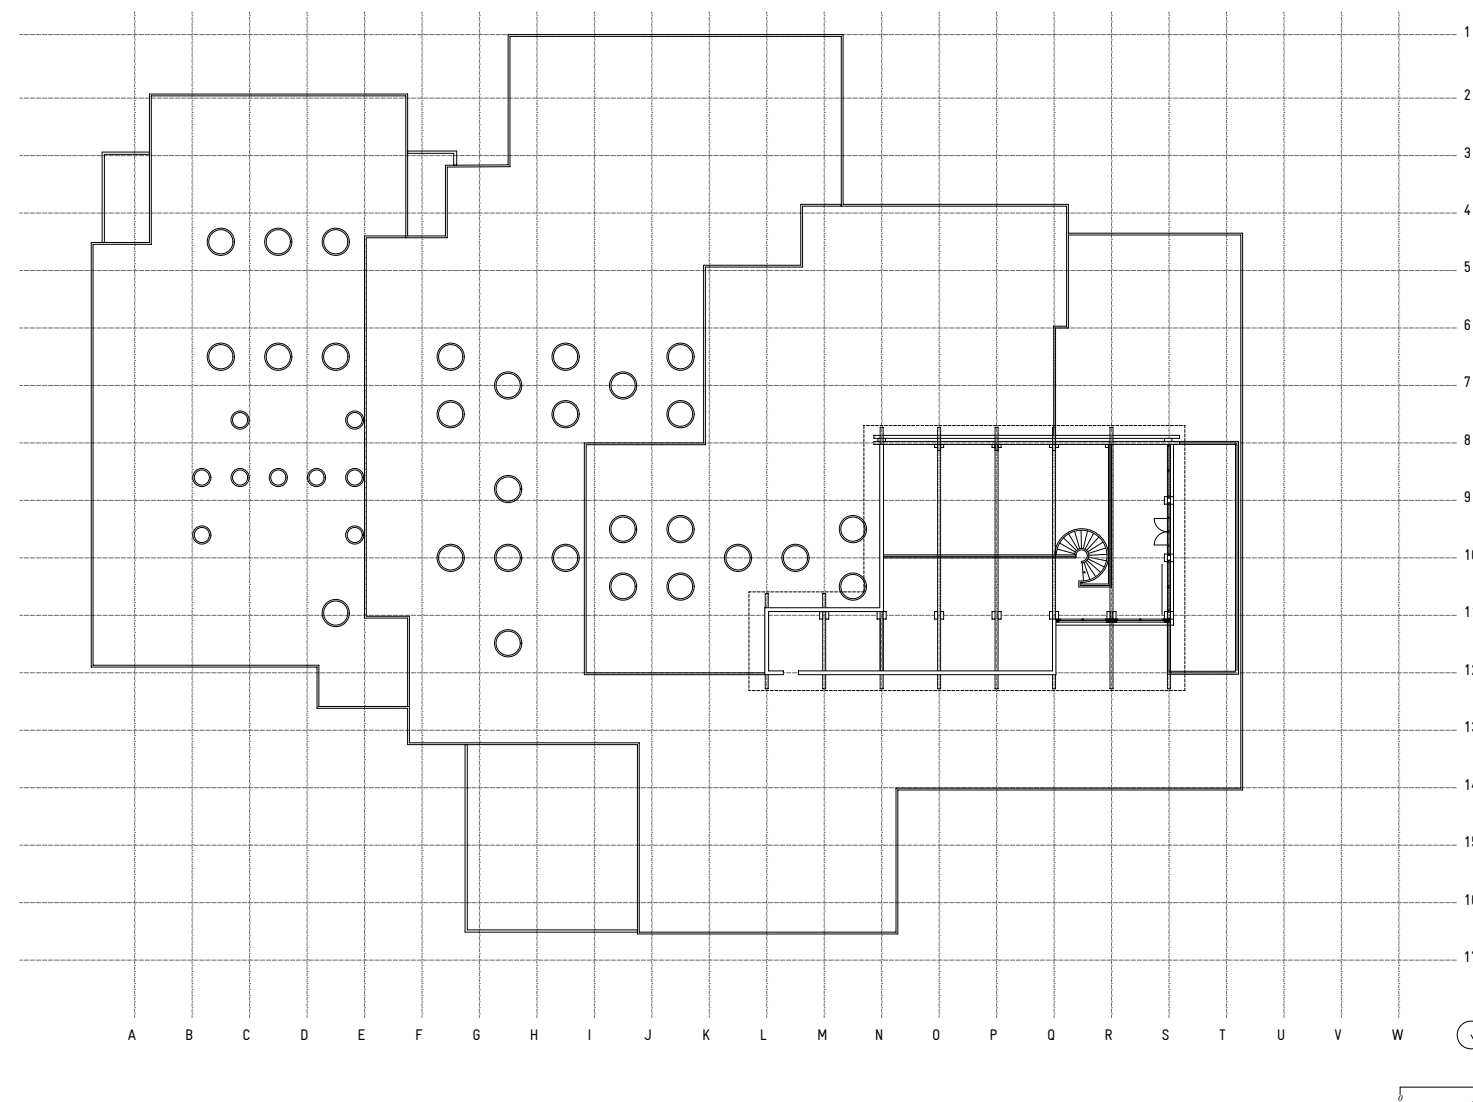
Grundriss Galerie, Dachdraufsicht 1:500, rekonstruiert
